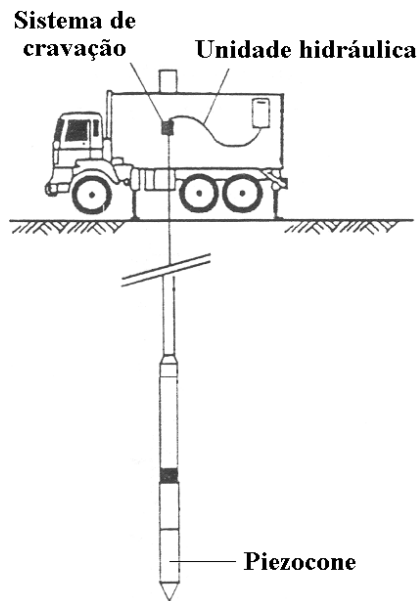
Detalhe de um conjunto montado sobre um caminhão (Adaptado – SCHNAID, 2000)
